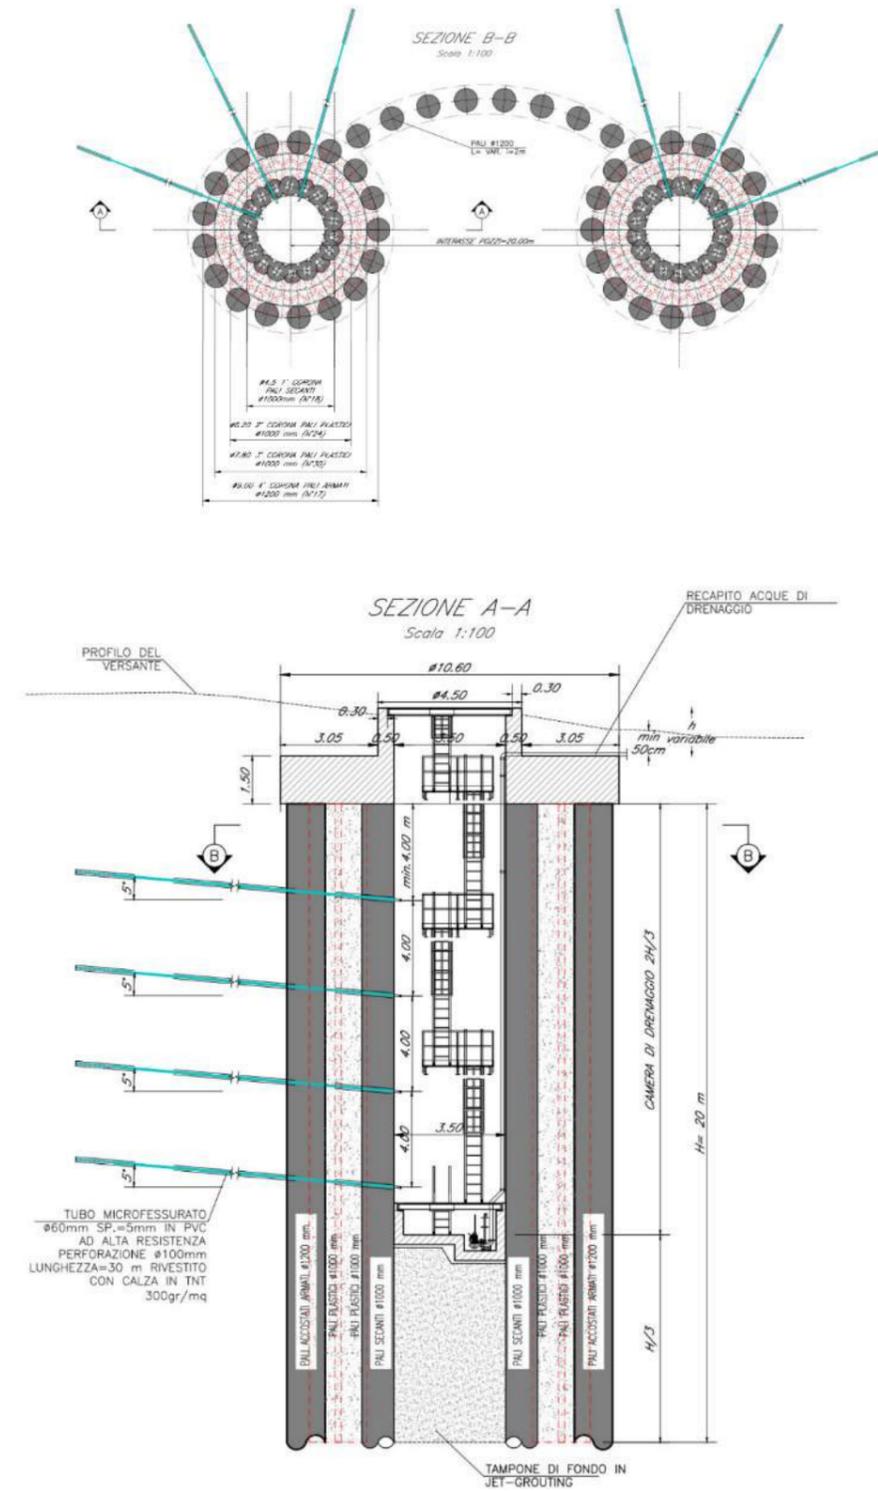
Stralcio carpenteria pozzi drenanti strutturali
